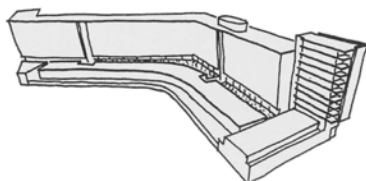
Bloque híbrido, adhesión de una casa-taller con patio en la planta baja del bloque Florijn, arquitectos Steehnhuis con oficina en Delft.
